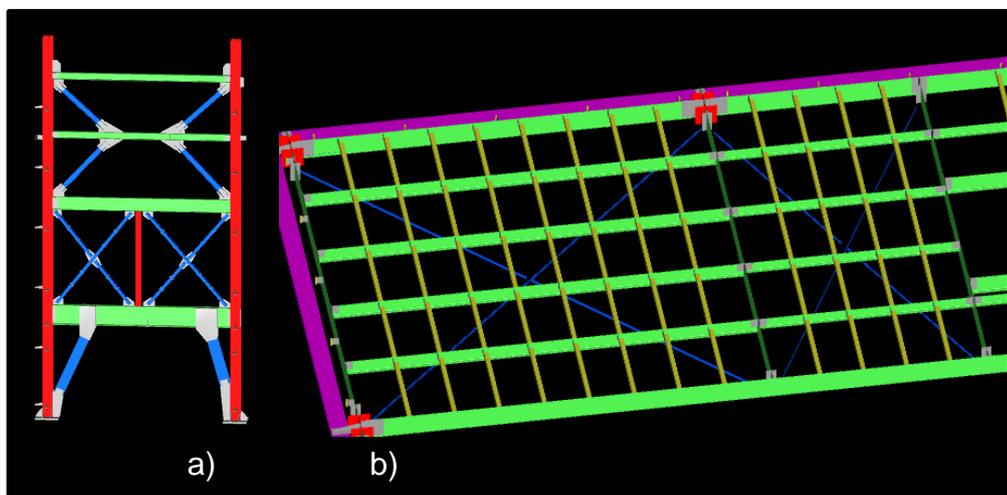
Exemplo de a) Pórtico e b) Elevação
